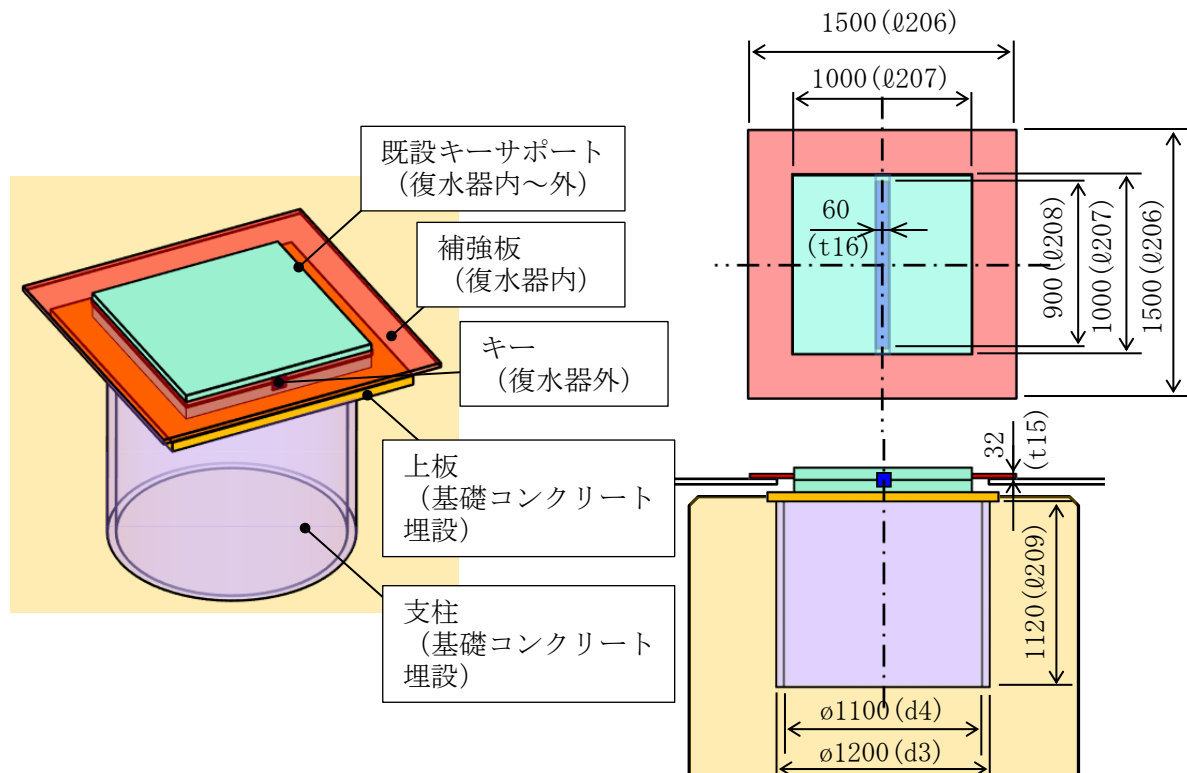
No. ⑦⑧ 既設キーサポート鳥瞰図, 平面図, 断面図
